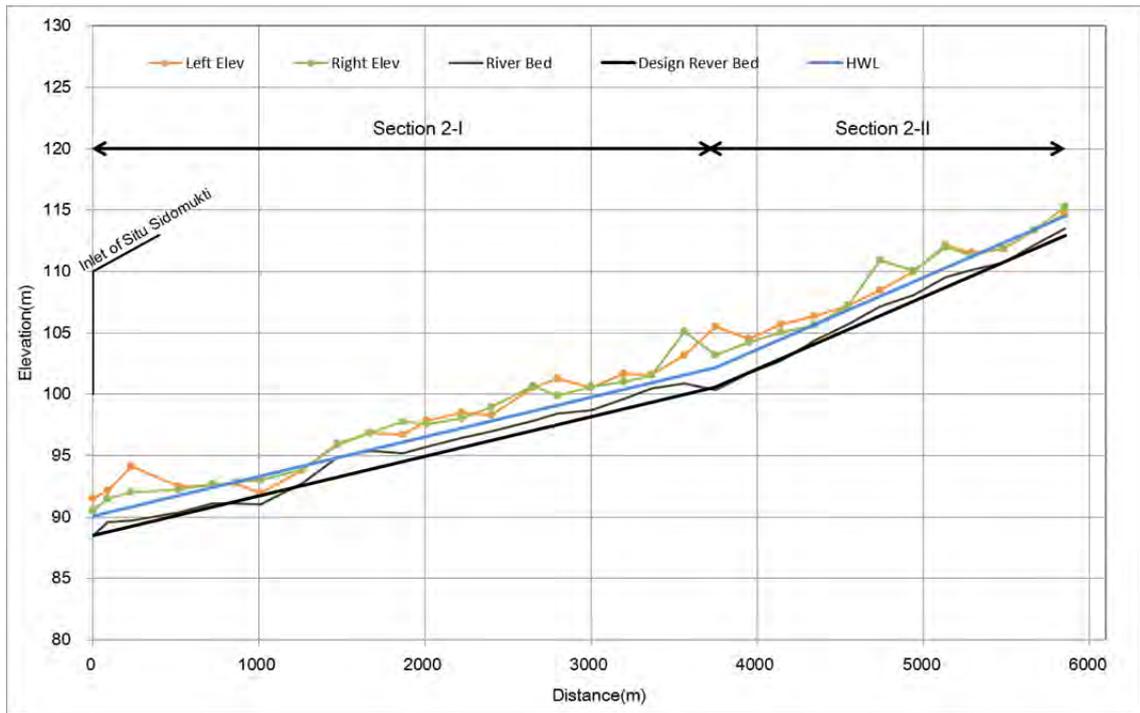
Situ Sidomukti 上流区間 計画縦断面図
